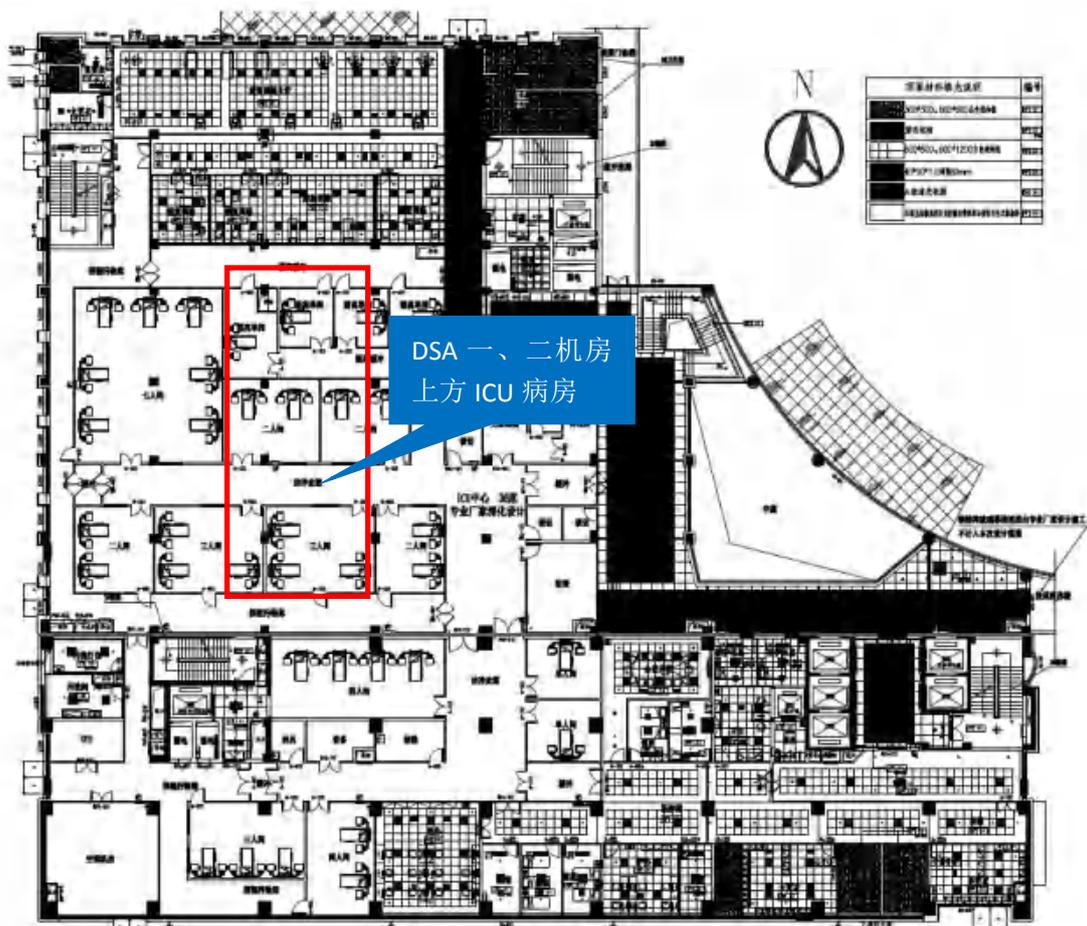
DSA 一、二机房上方楼层（2层）平面布置图
